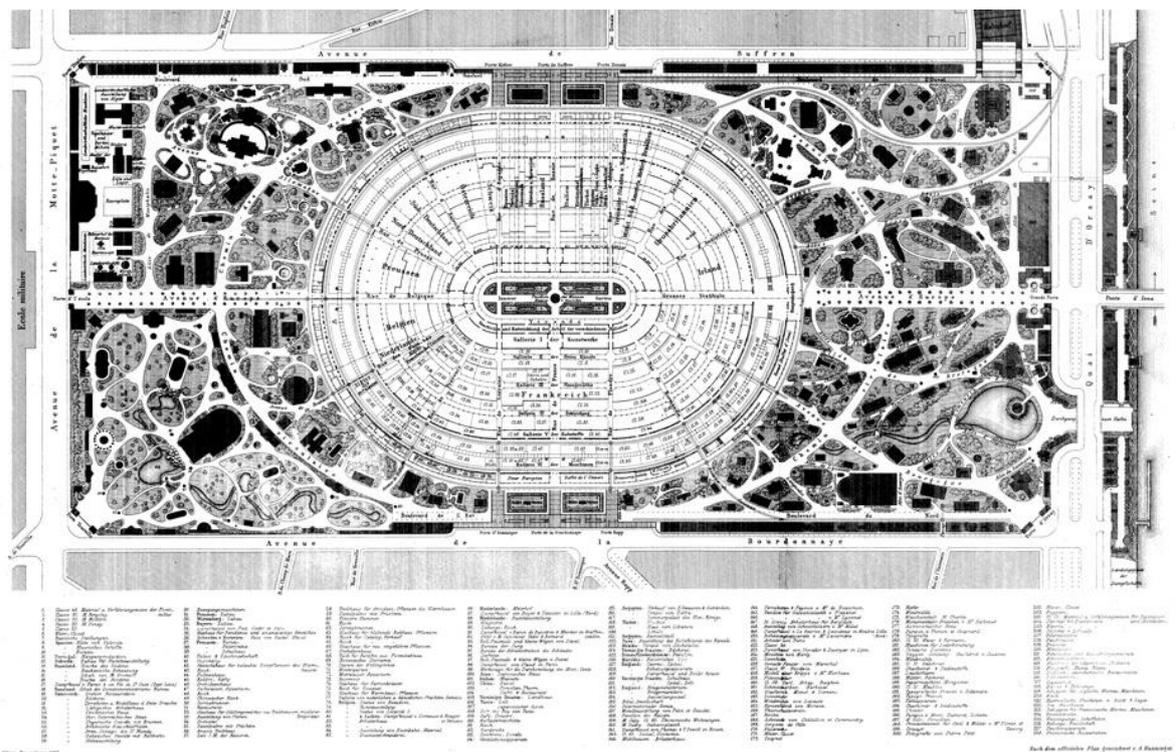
Ausstellungsgebäude für 1867. Situationsplan mit Parkanlage, Grundriss, Paris, 1867
